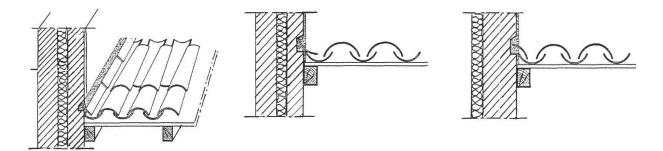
Extrémités du revêtement de toit sur les murs qui se poursuivent en hauteur
